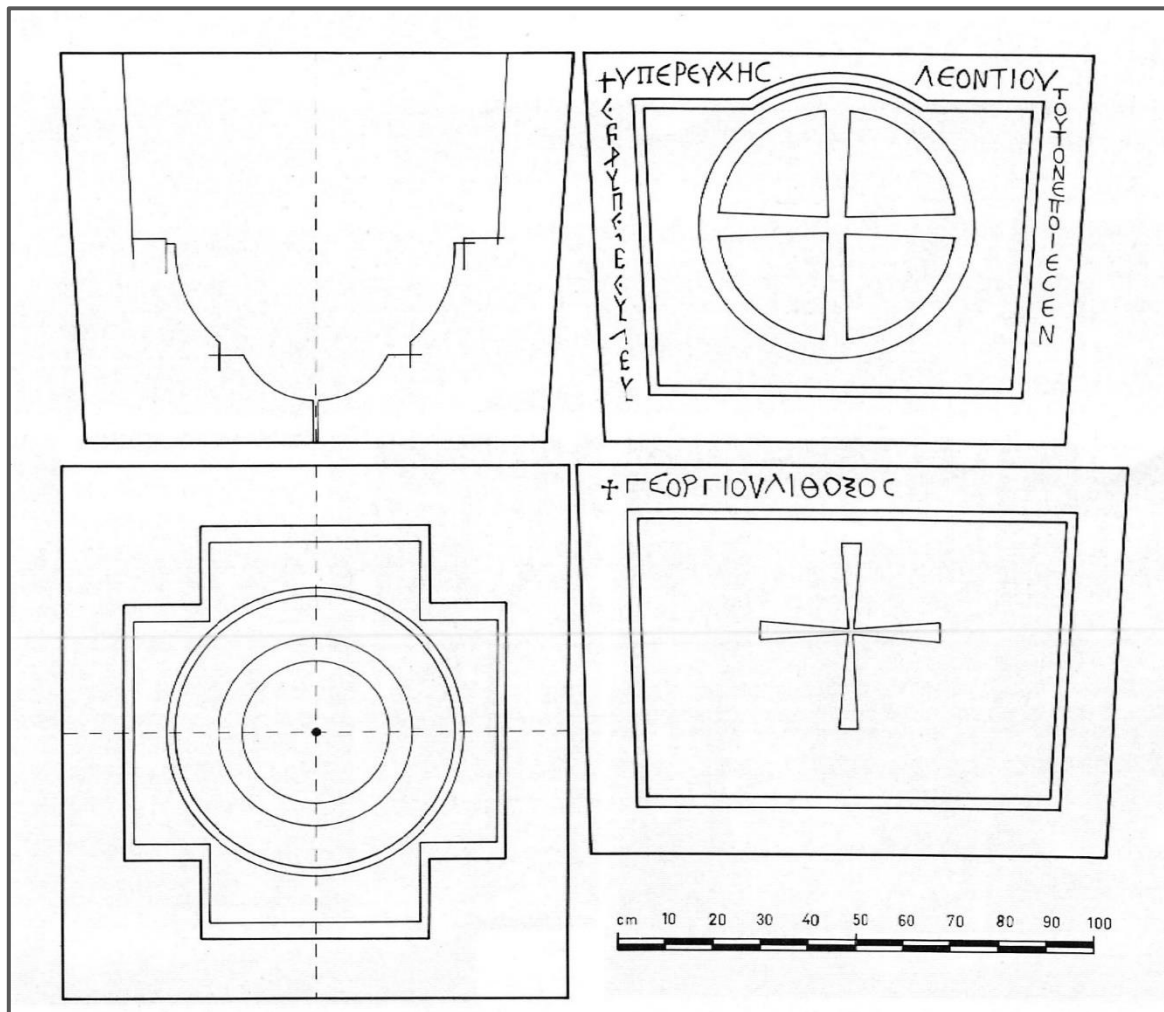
Hnak. Pianta, prospetto e sezione del fonte battesimale (Piccirillo 1977, Tav. 40).
